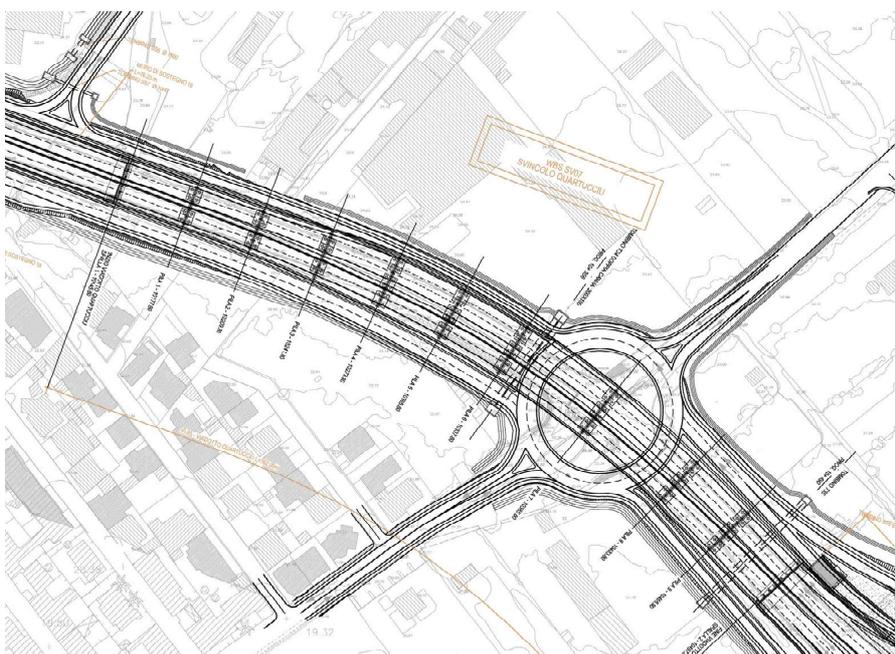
Inquadramento planimetrico – Viadotto Quartucciu
